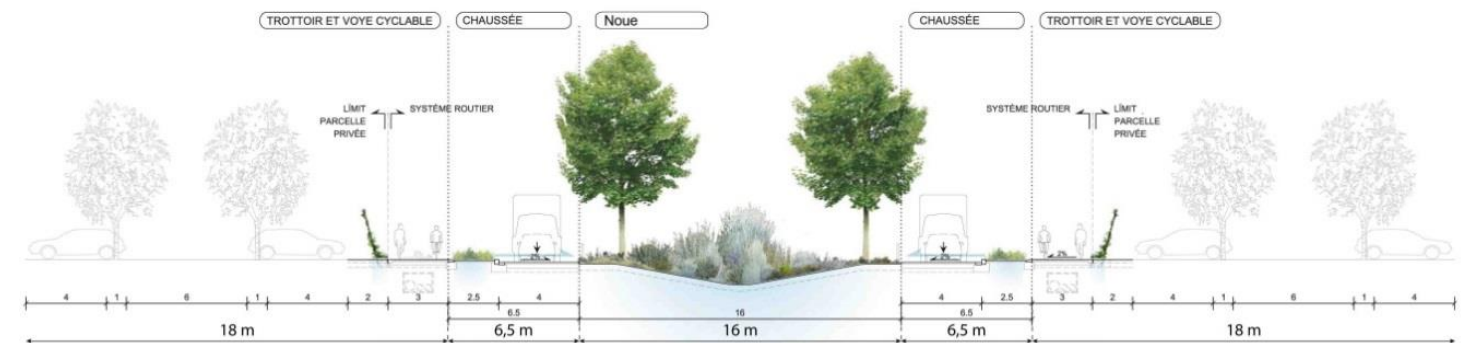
Coupe type du principe d'aménagement des chaussées, trottoirs et voie cyclable
